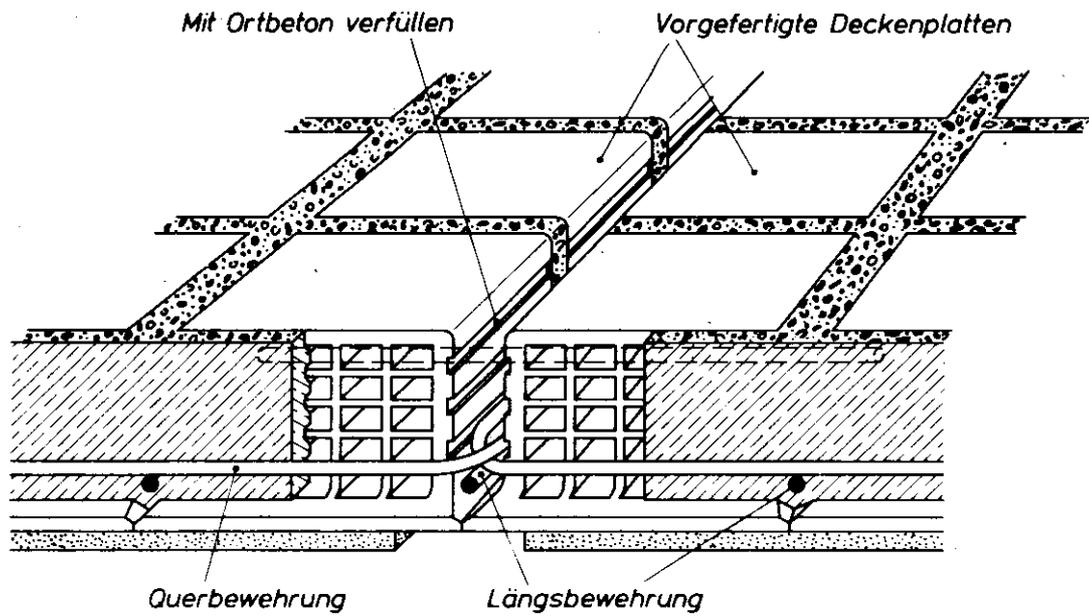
Verbindung zweier Deckenplatten aus Ziegeln mit vollvermörtelbaren Stoßfugen nach DIN 4159; Stoß mit abgeogener, in die nächste Querrippe eingreifender, Querbewehrung
